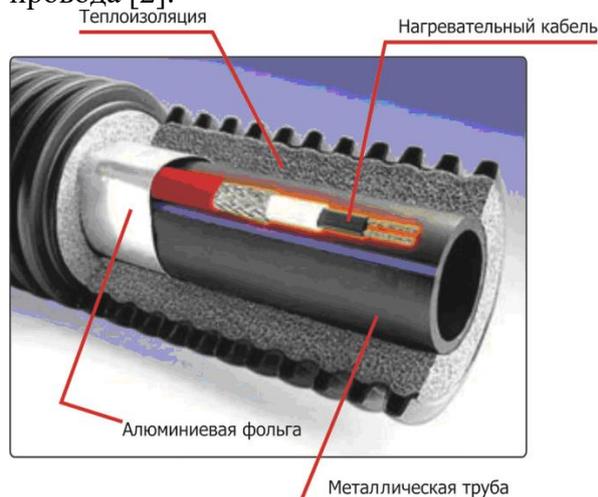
Обогрев трубопровода с помощью нагревательного кабеля.
